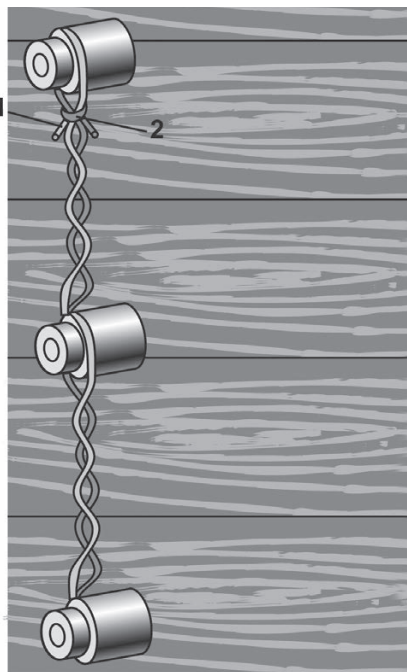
Крепление электропроводки на роликах: 1 — провод; 2 — тесьма
